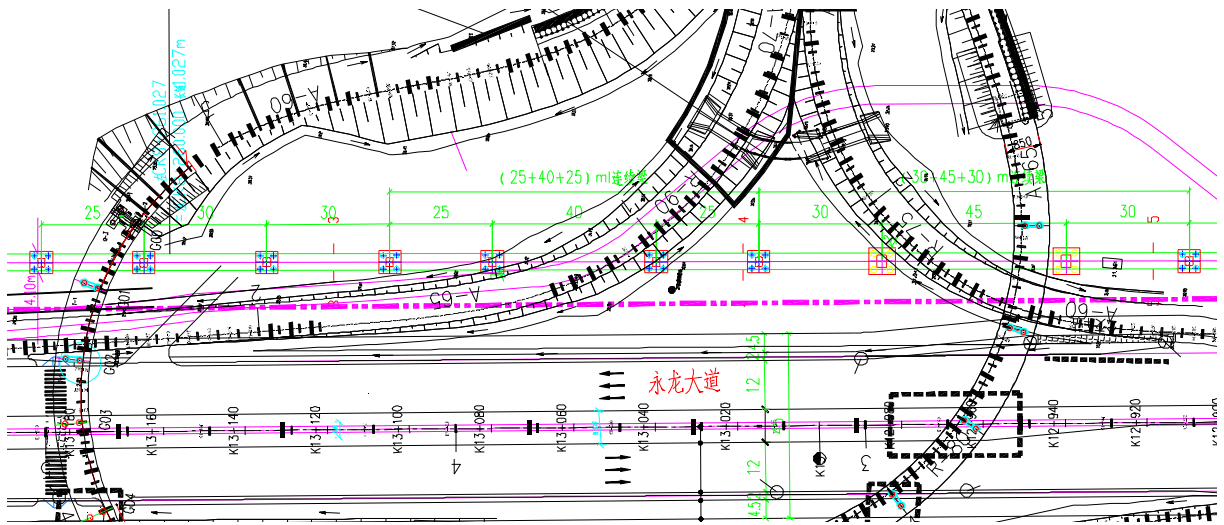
上跨花莞高速公路 F、G 匝道高架段平面图
